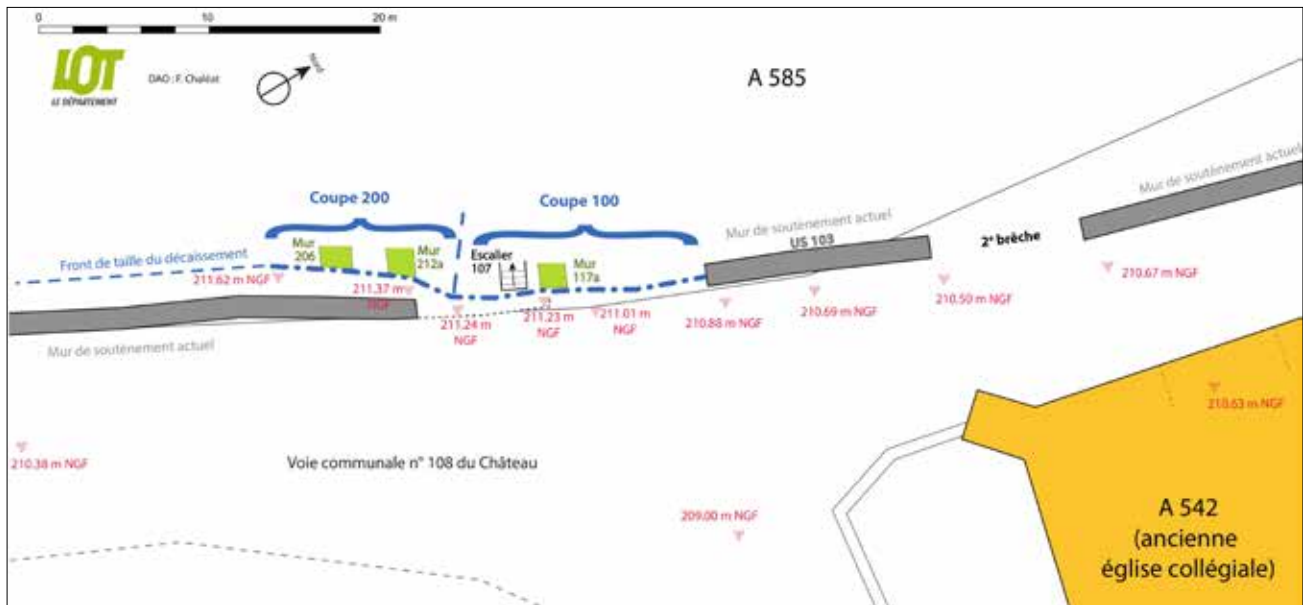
plan général de l'emplacement du mur de soutènement et des coupes relevées, avec la mention des murs visibles dans la coupe (DAO : Fr. Chaléat).
